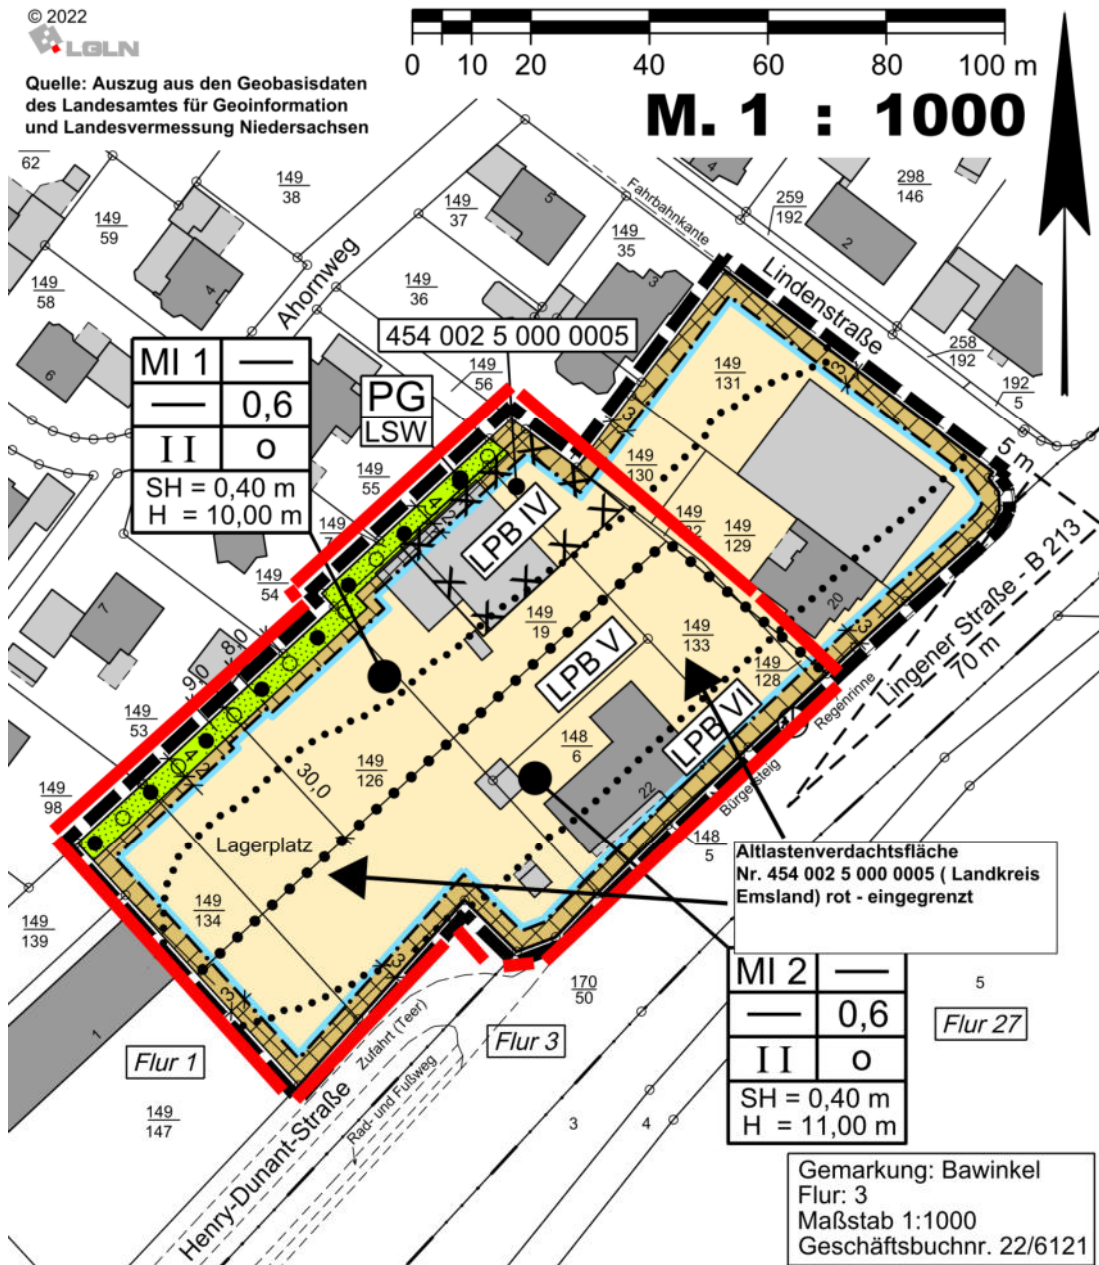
B-Plan Entwurf Nr. 44 mit Lage der Altlastenverdachtsfläche
